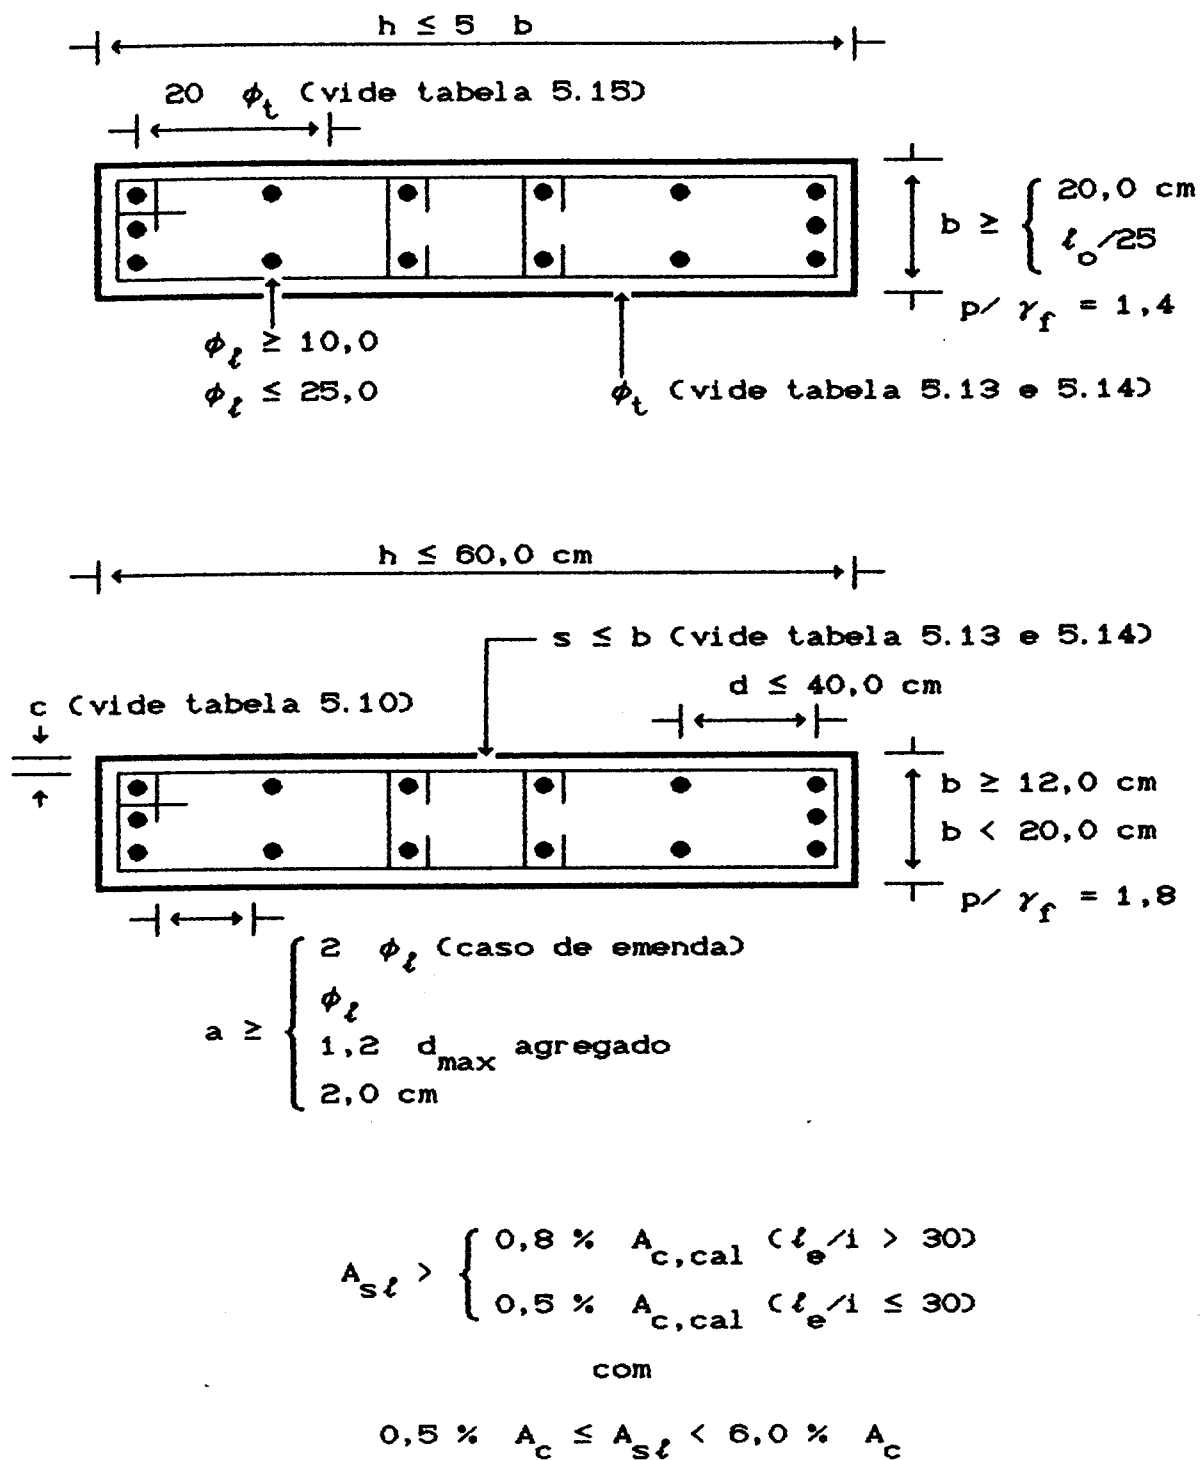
Resumo das disposições construtivas para pilares.
